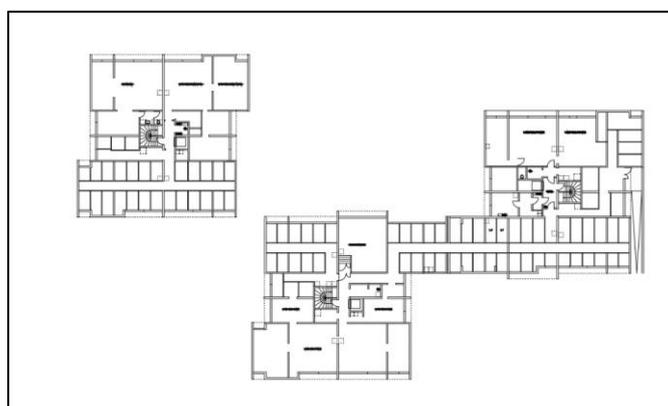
Plan des sous-sols. Source : GTM Bâtiment (2021)
